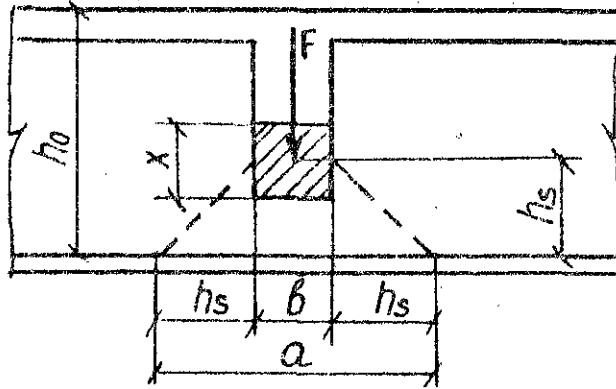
Схема для расчета железобетонных элементов на отрыв
